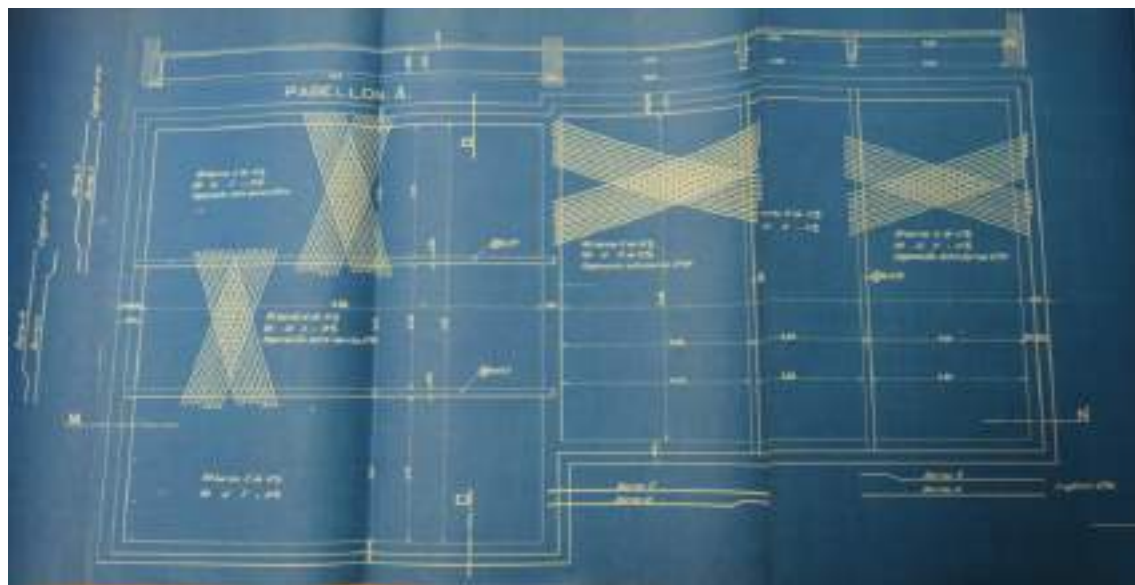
Azoteas de hormigón armado para cubierta de los pabellones laterales del edificio de viajeros, Planta (Escala 1:200), Sección por C.D., Sección por A.B., Sección Longitudinal, Sección transversal (Escala 1:29), Proyecto de ejecución, 1905, "Construcción de dos azoteas de hormigón armado para cubrir los pabellones laterales del nuevo edificio de viajeros de la estación de Cartagena. Contratista la Compañía Anónima de Hormigón Armado de Sestao,". AHF-MFM.. signatura C965 1/4.
